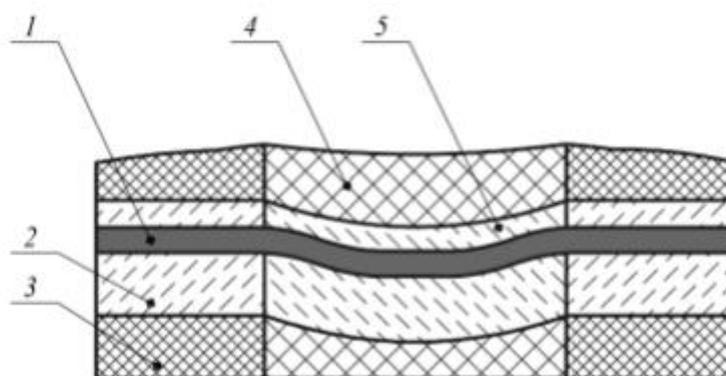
Схема осадки подземного нефтепровода: 1 – нефтепровод; 2 – оттаявший непросадочный грунт; 3 – мерзлый непросадочный грунт; 4 – мерзлый просадочный грунт; 5 – оттаявший просадочный грунт
